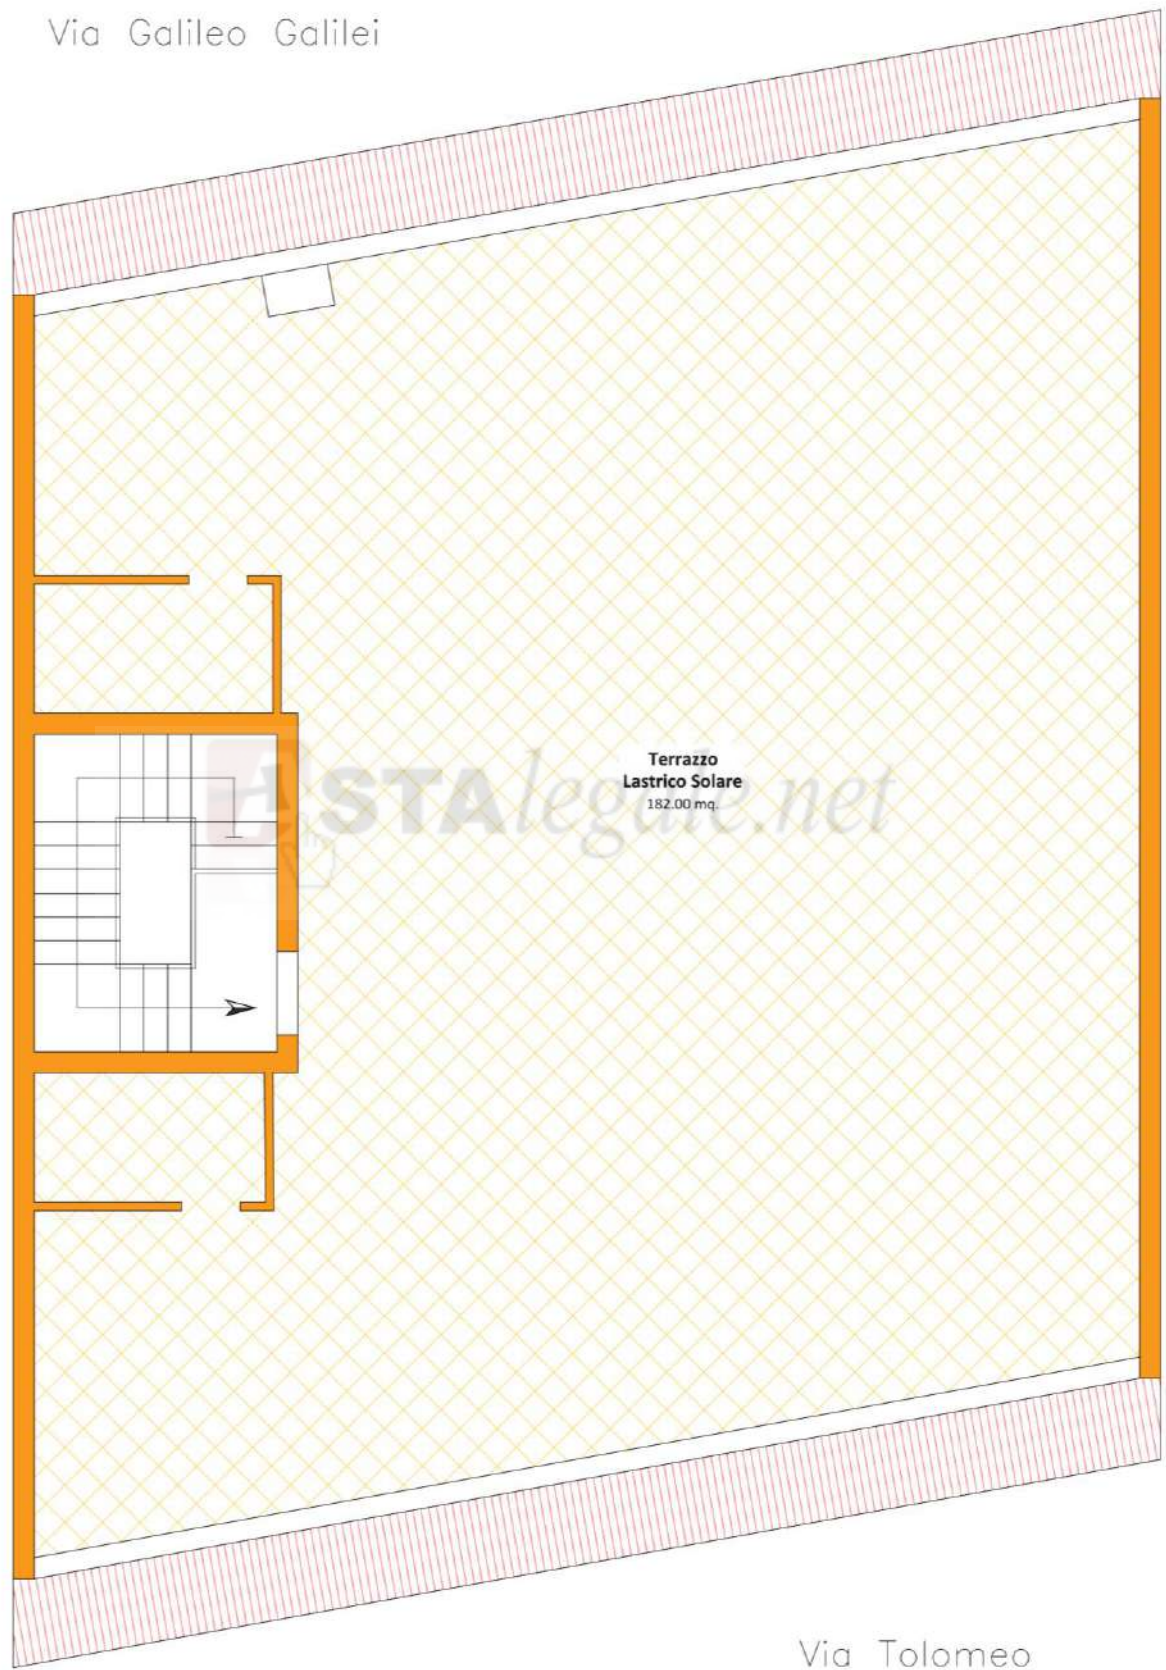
PIANTA PIANO COPERTURA "TERRAZZO" - Sub 6.
